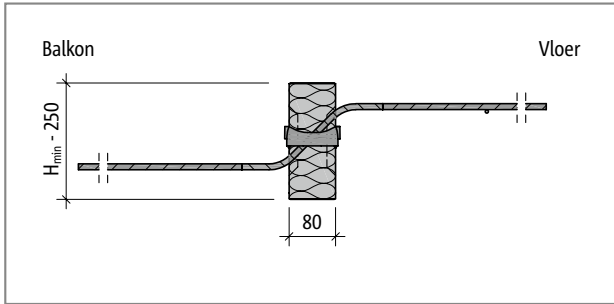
Schöck Isokorb® T type Q-E-V7-L500: Bovenaanzicht
